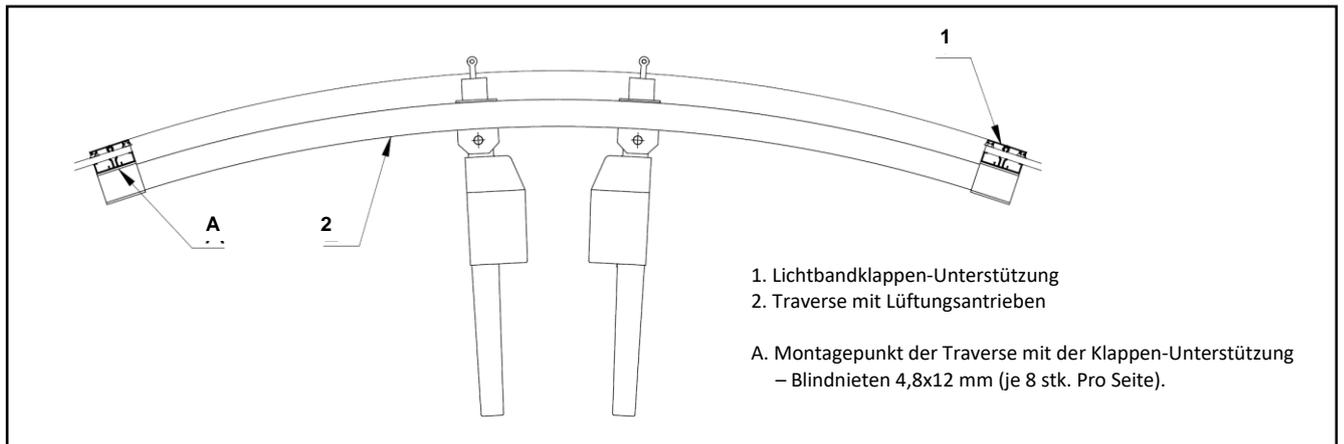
Montage der Traverse mit Lüftungsantrieben in der Lüfter-Klappe
